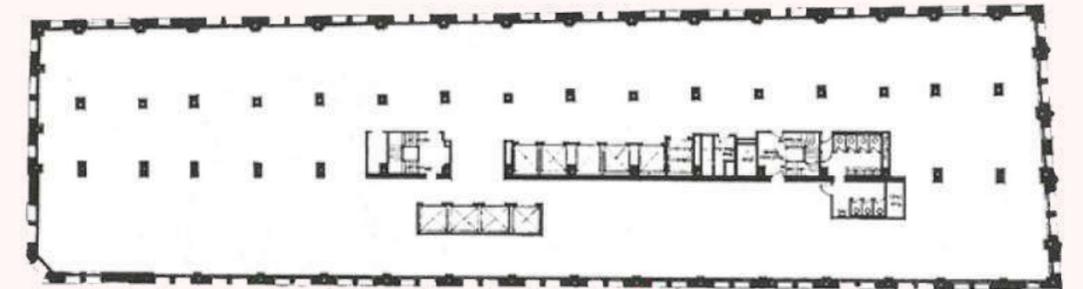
Planta baixa 1251, Avenue of the Americas, 1971
